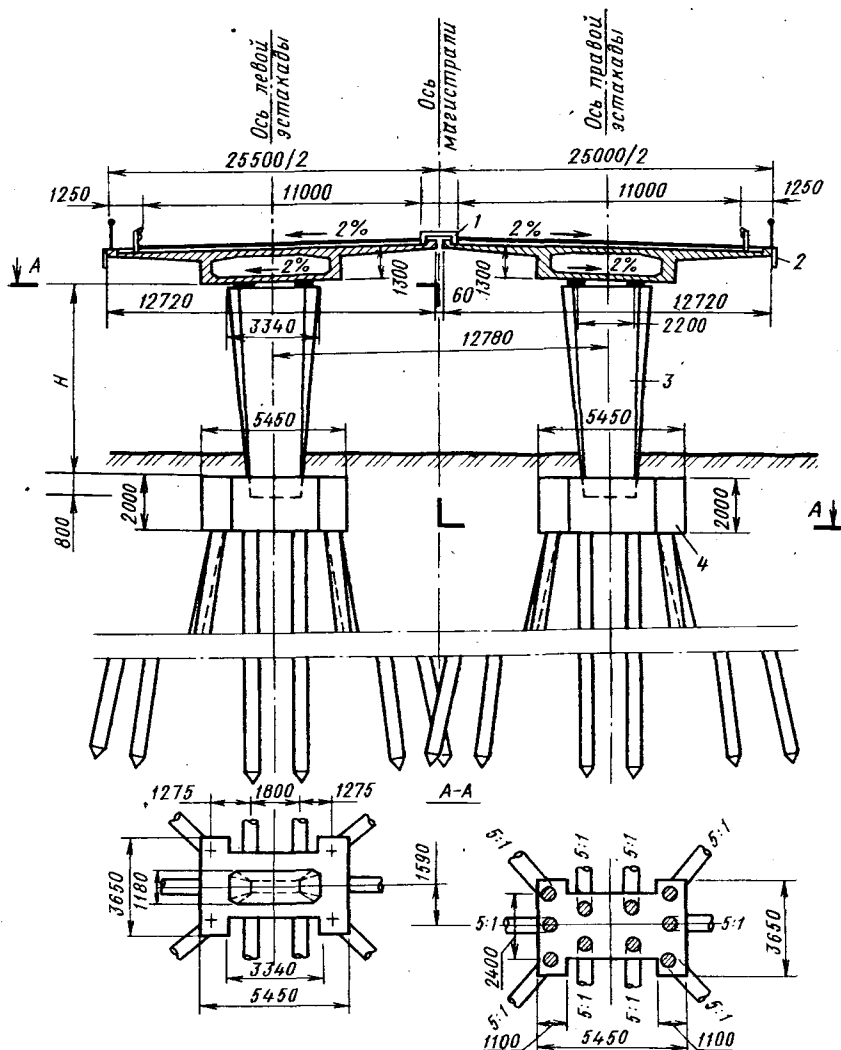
Поперечный разрез путепровода: 1 — блок разделительной полосы; 2 — карнизный блок; 3 — блок тела опоры; 4 — плита ростверка из монолитного железобетона; 5 — железобетонные сваи $d=0,6$ м, $l=16\div 24$ м; H — высота опор от 5,8 до 7,3 м
